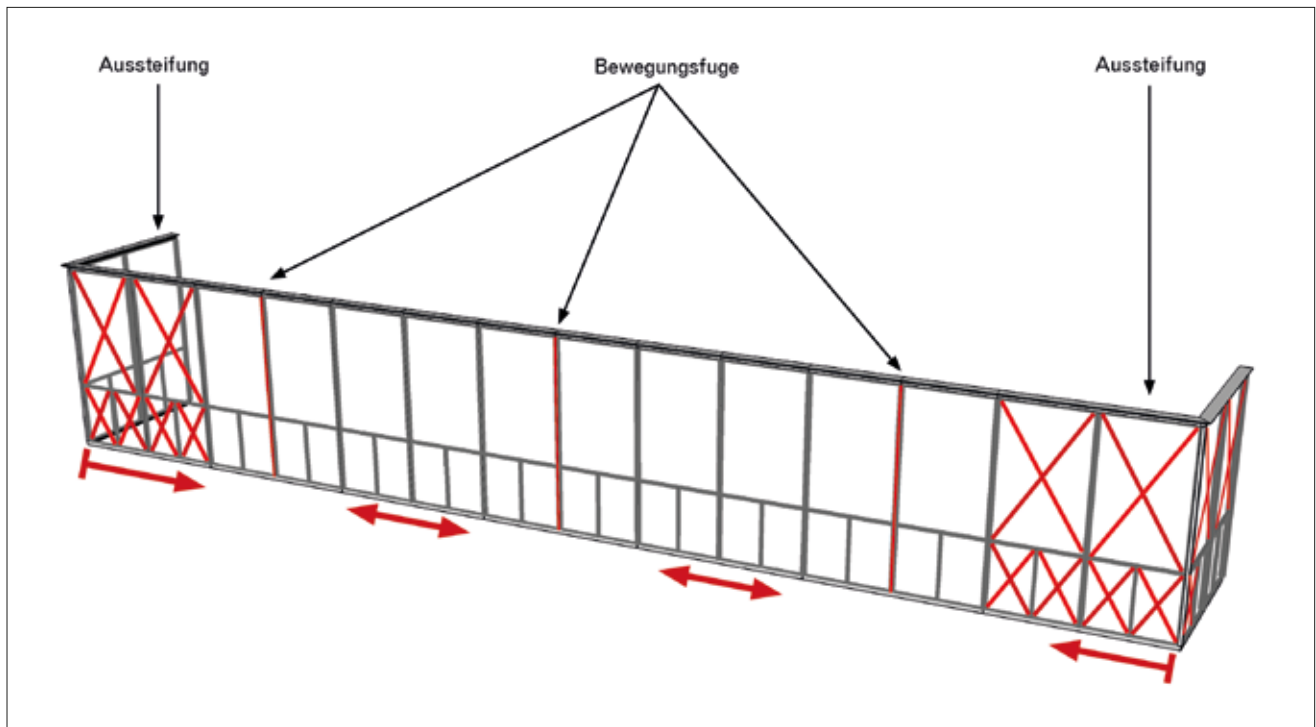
Sanierungskonzept Stahl-Glas-Fassade obere Halle
